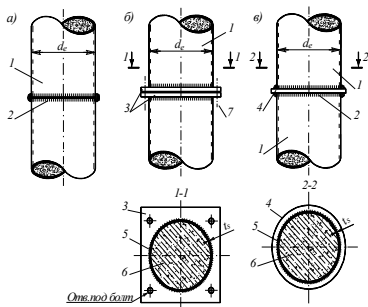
Некоторые типы стыков центрально сжатых трубобетонных элементов: а - "сухой" стык впритык; б - фланцевый стык; в - стык через металлическую прокладку; 1 - трубобетонный элемент; 2 - сварочный шов; 3 - соединительные фланцы; 4 - металлическая соединительная прокладка; 5 - стальная труба; 6 - бетонное ядро; 7 - ось отверстия
